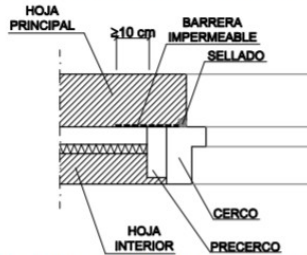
Encuentro de la fachada con carpintería. Fuente: DB-HS
